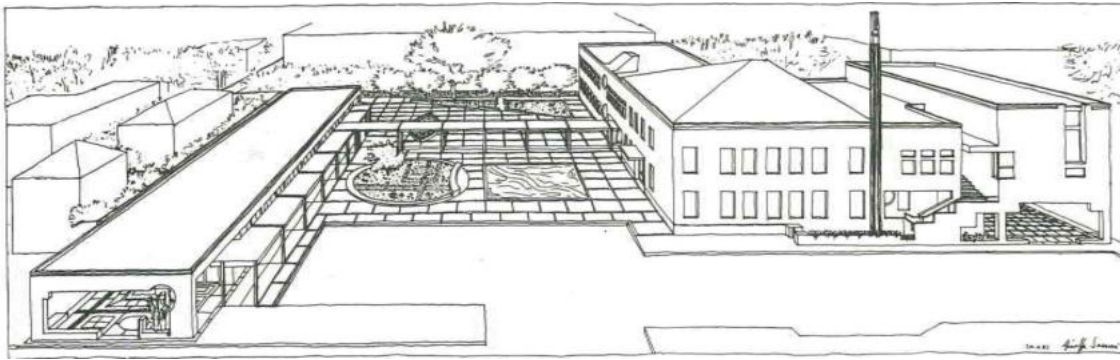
Giuseppe Samonà, prospettiva aerea di progetto (vista sud) della Piazza Insurrezione
